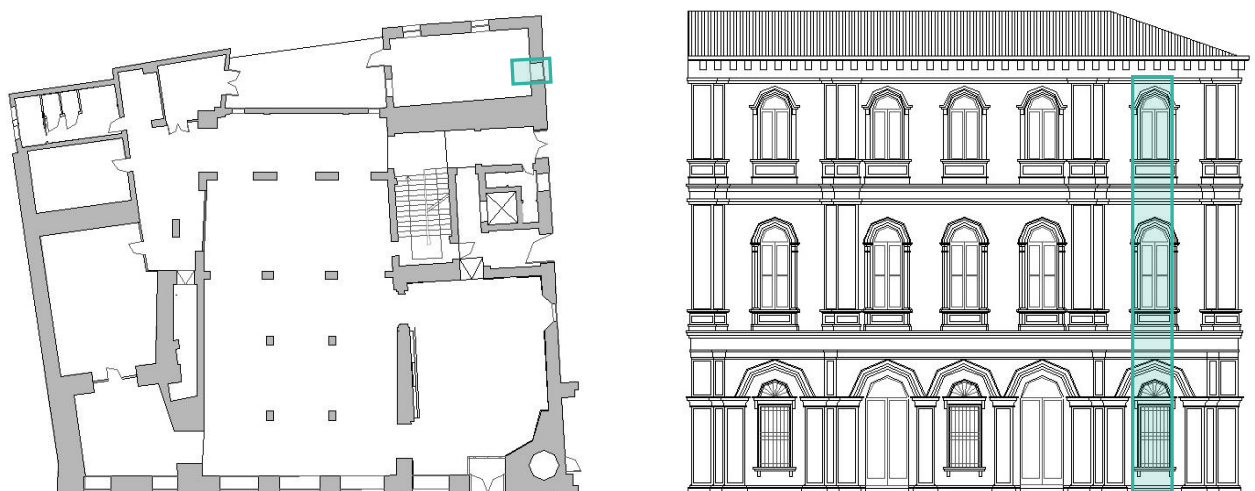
Individuazione macroelemento, pianta e prospetto
